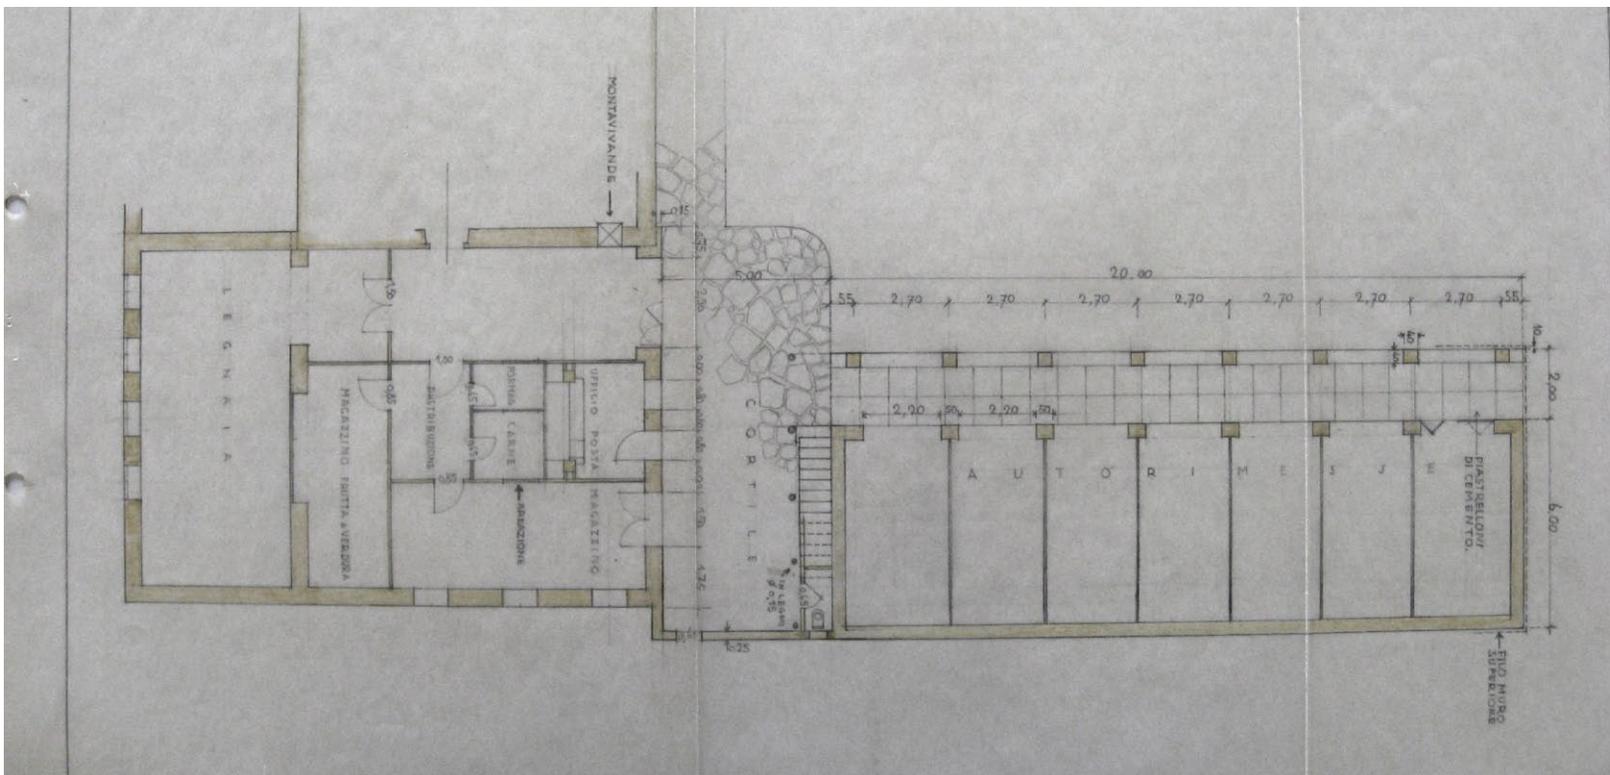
Grundriss EG: Lagermöglichkeiten für die Küche, sowie Garagen
